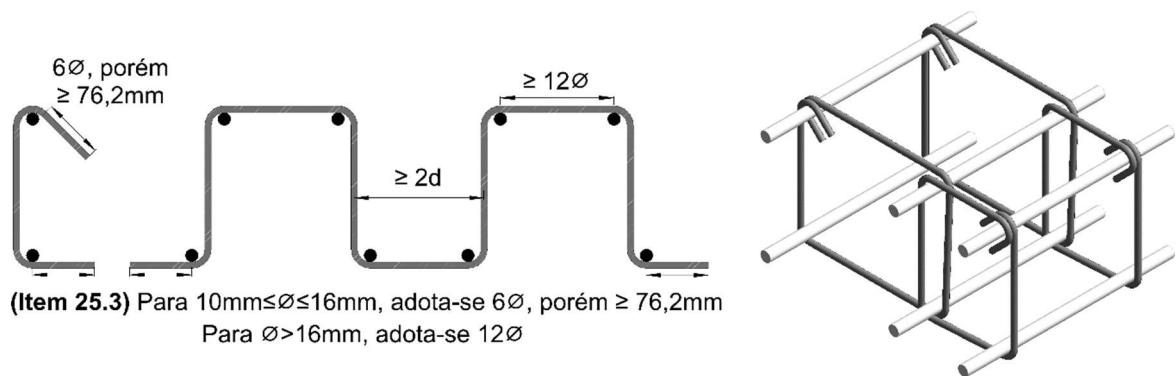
Detalhamento da ancoragem de estribos conforme ACI318 (2019)
